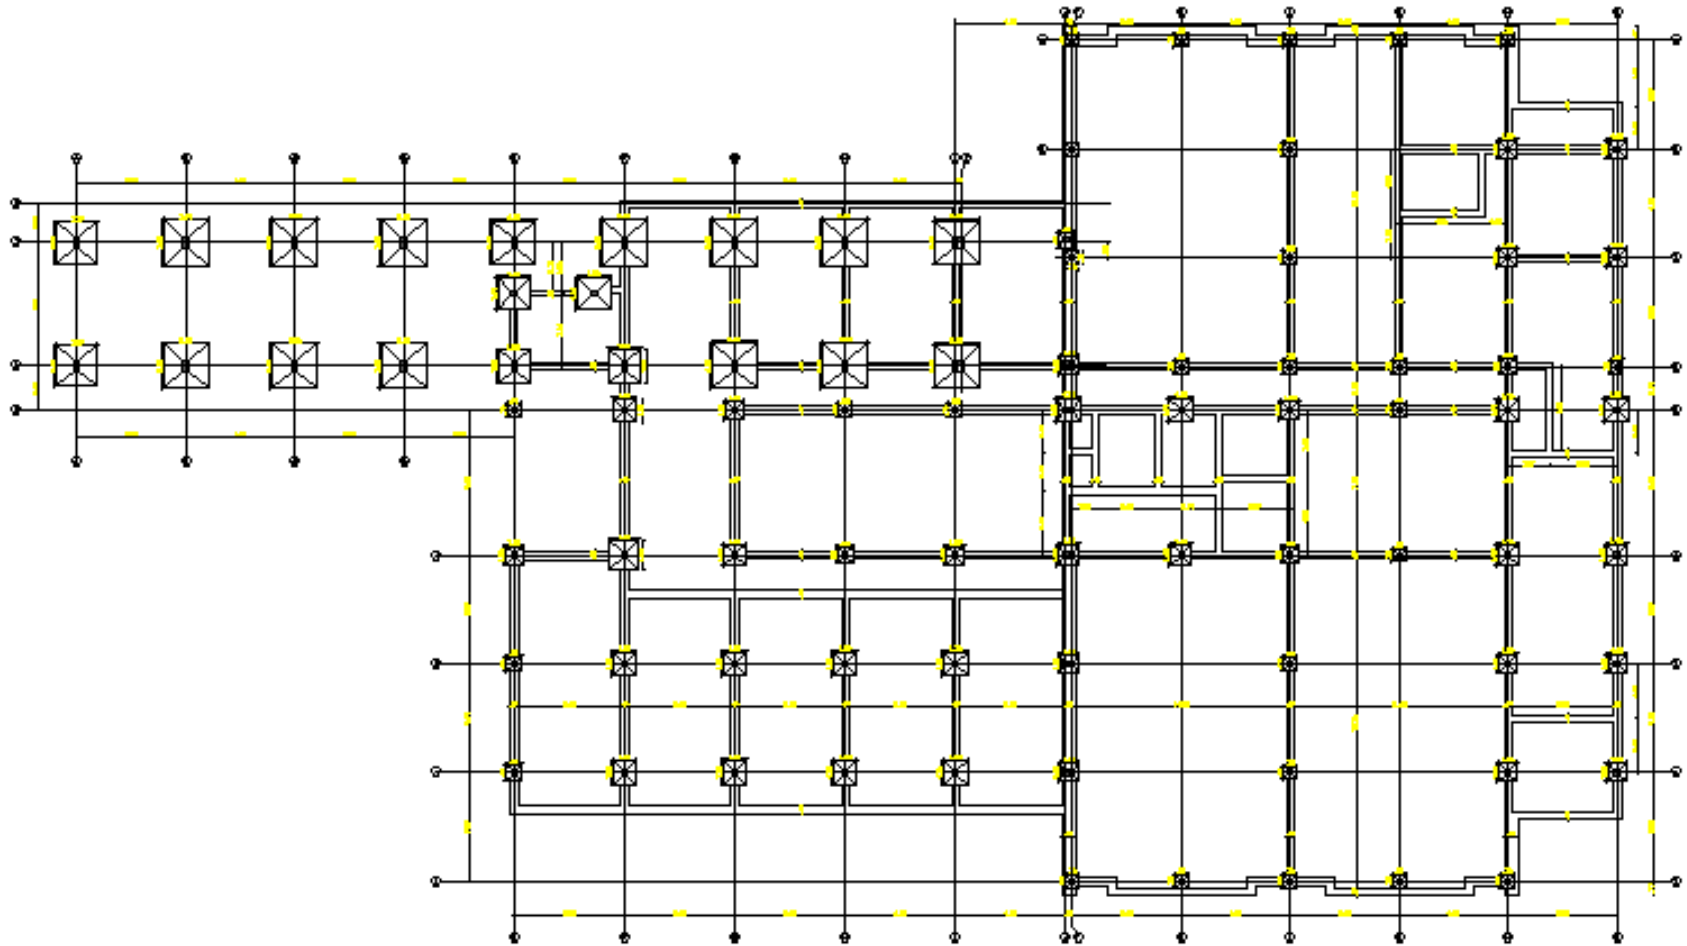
Cimentación de la Torre Oriente y de Estructuras 4.1 4.2 y 4.3
